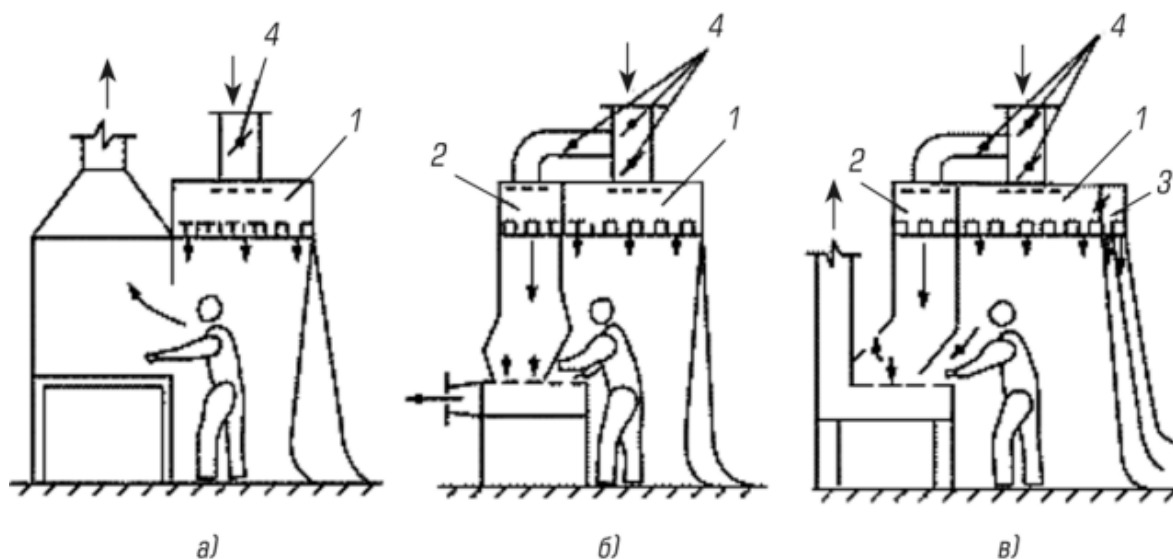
Аэродинамические схемы местной приточно-вытяжной вентиляции:
